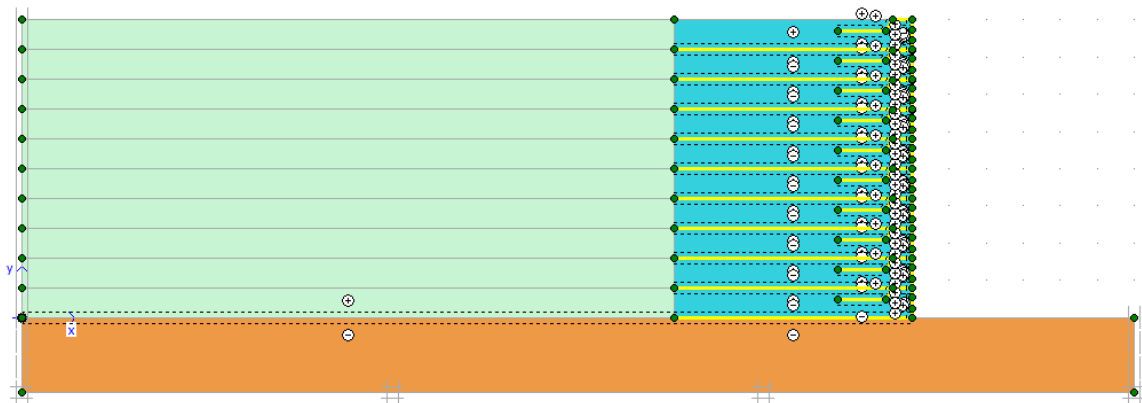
Estágio de cálculo após da construção da camada 10.
